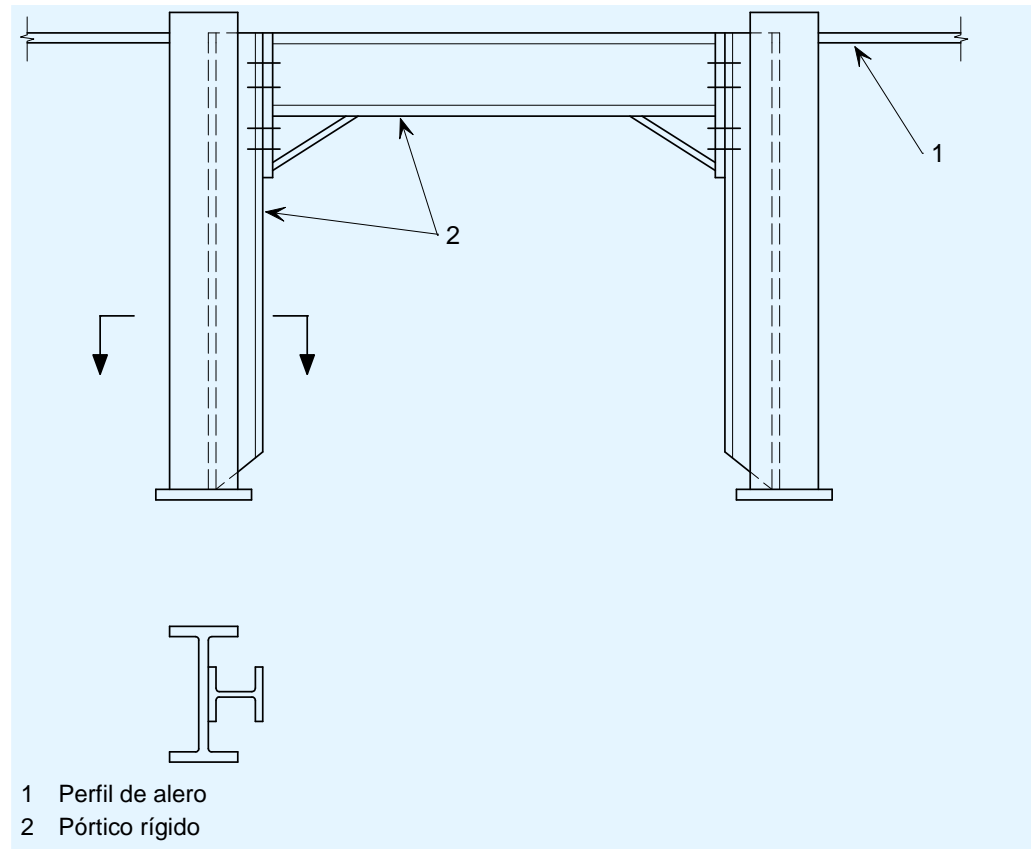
Alternativa al arriostramiento: estructura rígida
